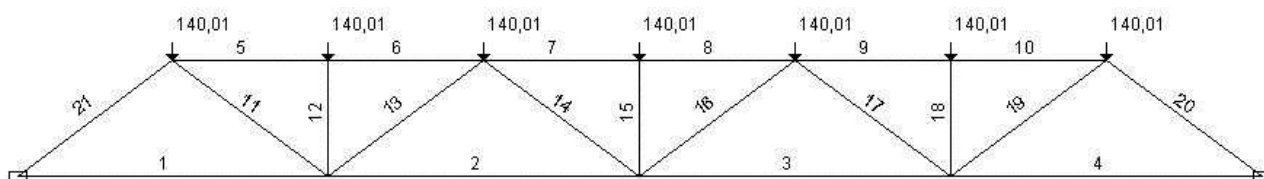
Вид расчётной схемы фермы с нумерацией элементов и узловыми нагрузками
